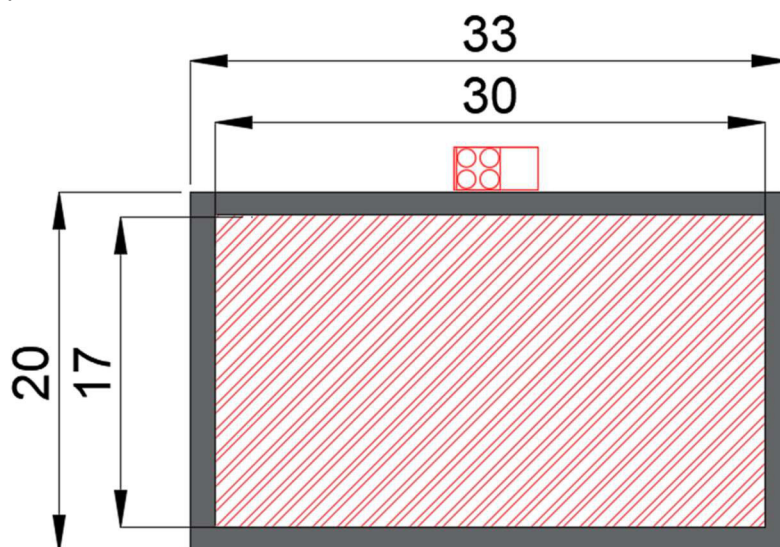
Dimensioni esterne della cabina CEB nel primo *layout*, espresse in metri
